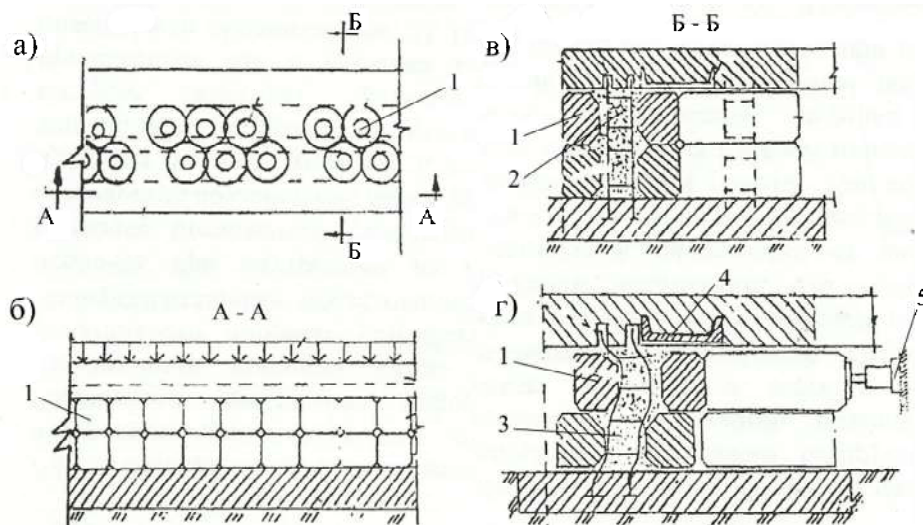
Сборные конструкции сейсмоизолирующего фундамента. а - общий вид – план; б – разрез А-А; в – разрез Б-Б; г – деформированное состояние фундамента и схемы восстановления, 1 – железобетонные кольца; 2 – упругие связи; 3 – арматурный каркас; 4 – жесткая арматура – швеллер; 5 - домкрат
